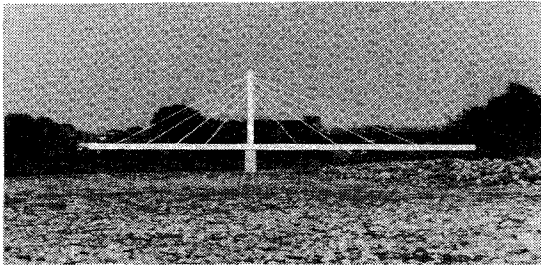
(c) CASE-2の橋梁形式 (2径間連続鋼斜張橋)
